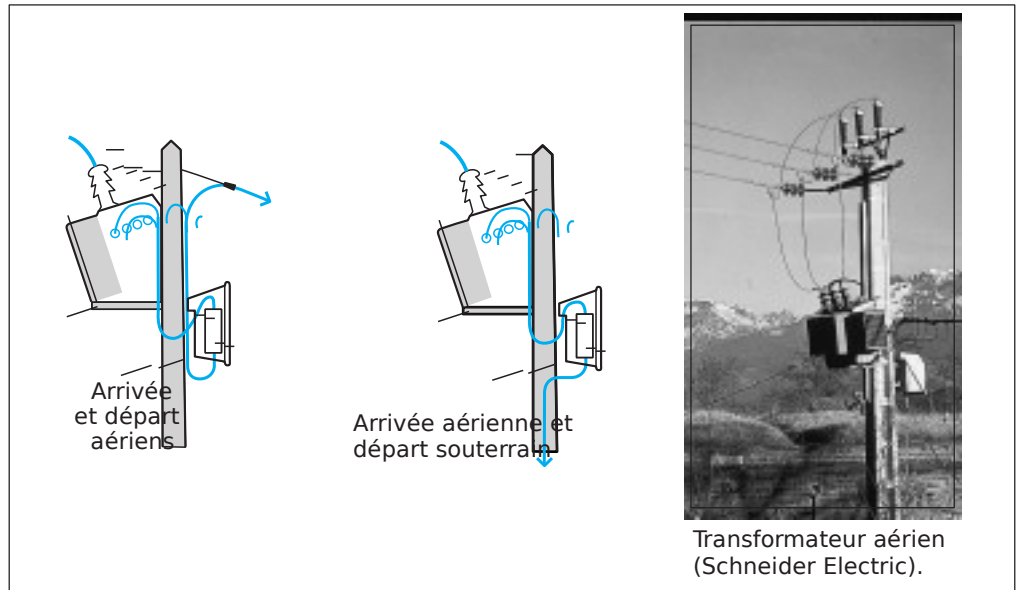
Exemples de raccordement d'un poste sur poteau.
